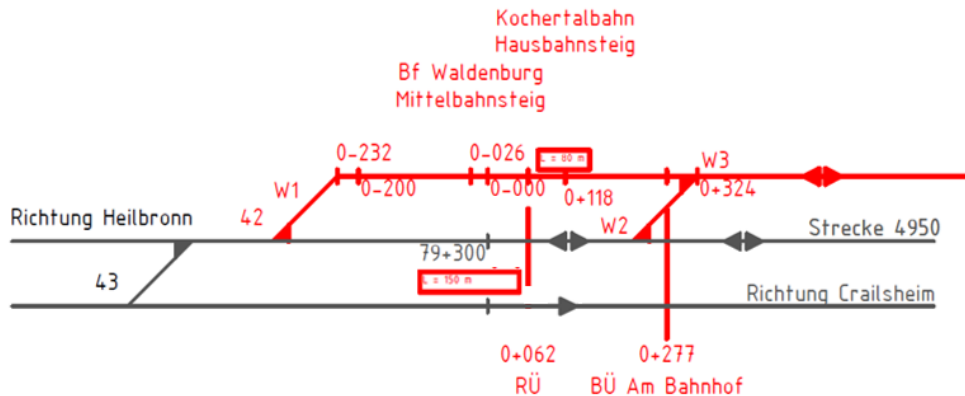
Spurplanskizze Bahnhof Waldenburg (Ausschnitt aus Streckenband, TTK)
